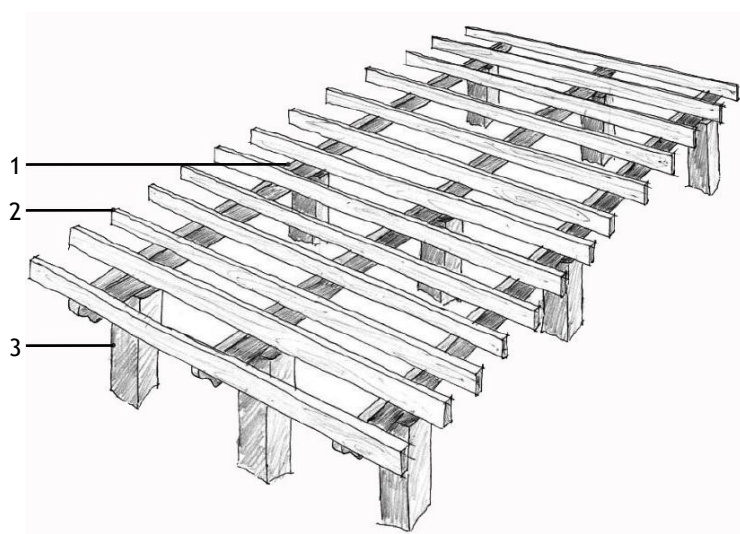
Desenho da estrutura tipo de um sobrado. [5]
